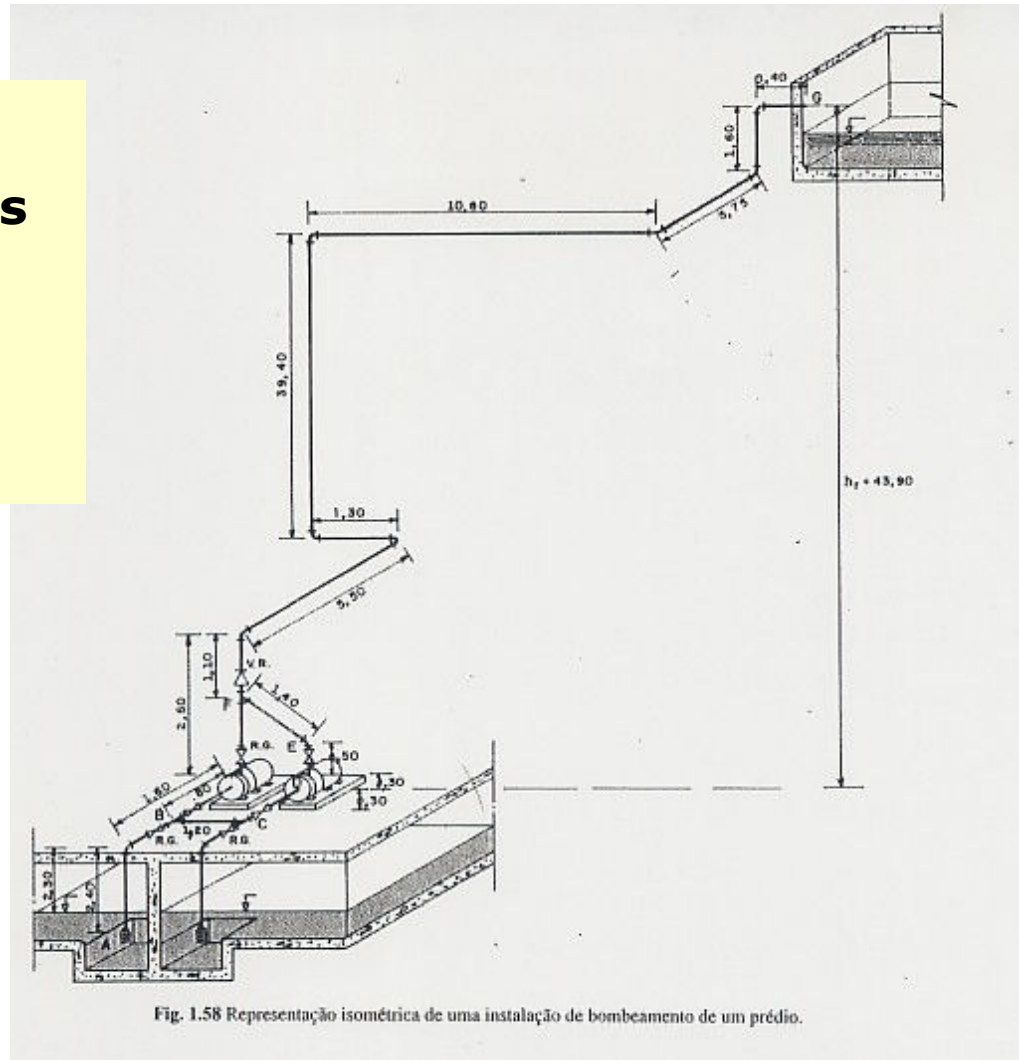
Representação isométrica de uma instalação de bombeamento de um prédio.
